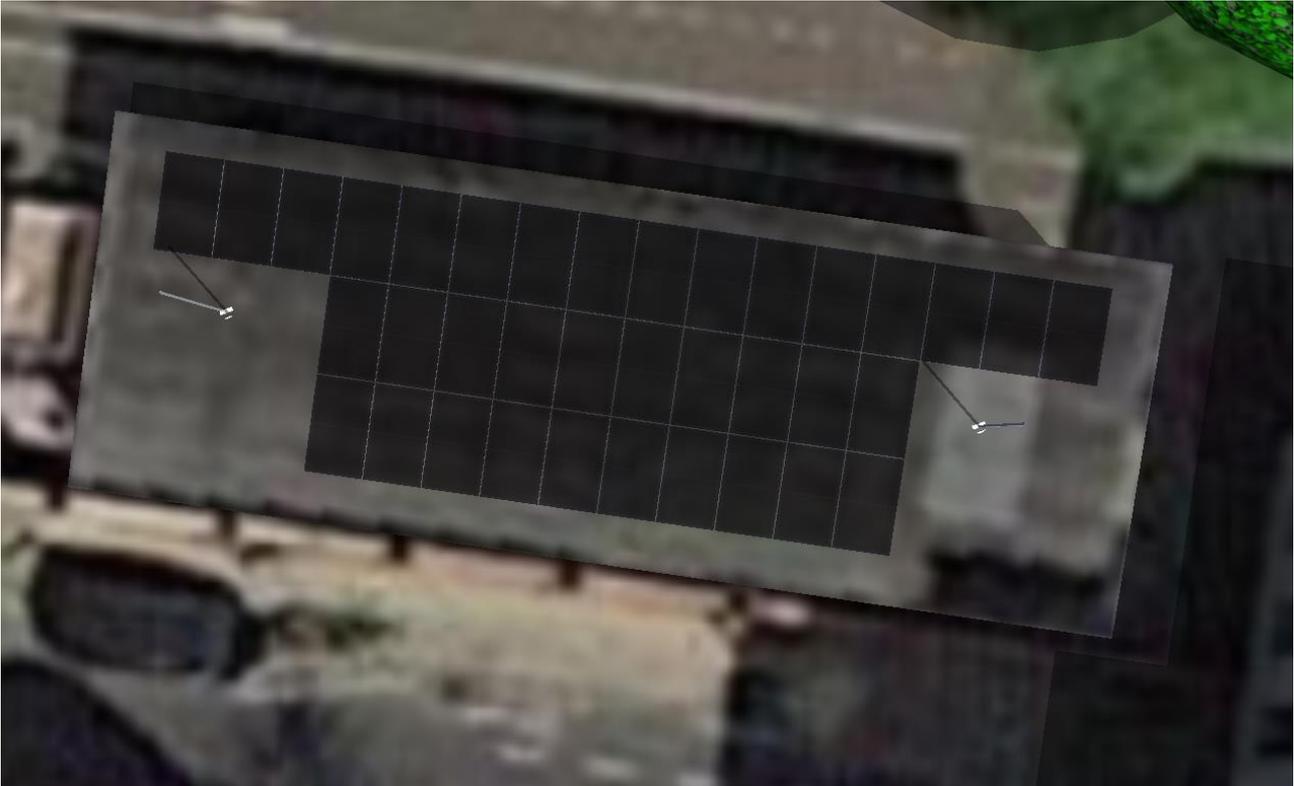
PV-Anlage – genordnete Draufsicht Variante „maximal installiere Leistung“ (PVSOL*premium)
